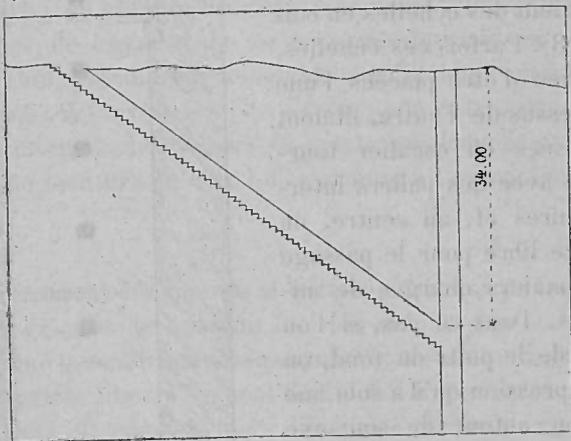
Coupe longitudinale du puits des Escaliers (Échelle $\frac{1}{4000}$).
